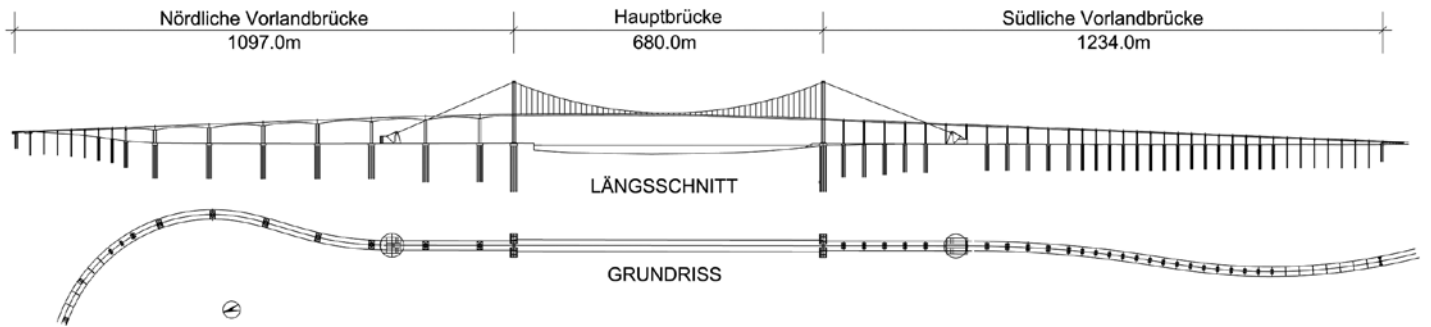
Grundriss und Seitenansicht der Gesamtbrücke
